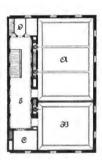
Grundrisse der Loge "Friedrich Wilhelm zur Eintracht".
